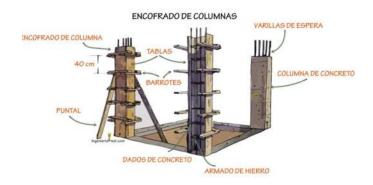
Columna de concreto armado. Fuente: Google (19/07/21)
